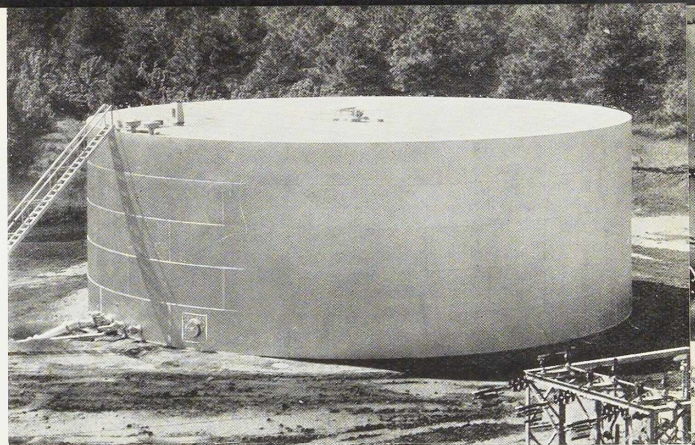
Vue d'un tank Wiggins muni d'un toit respirant, construit à Houston, Texas, par la Chicago Bridge and Iron Works. Capacité : 4.225 m³. Diamètre : 24 m.
